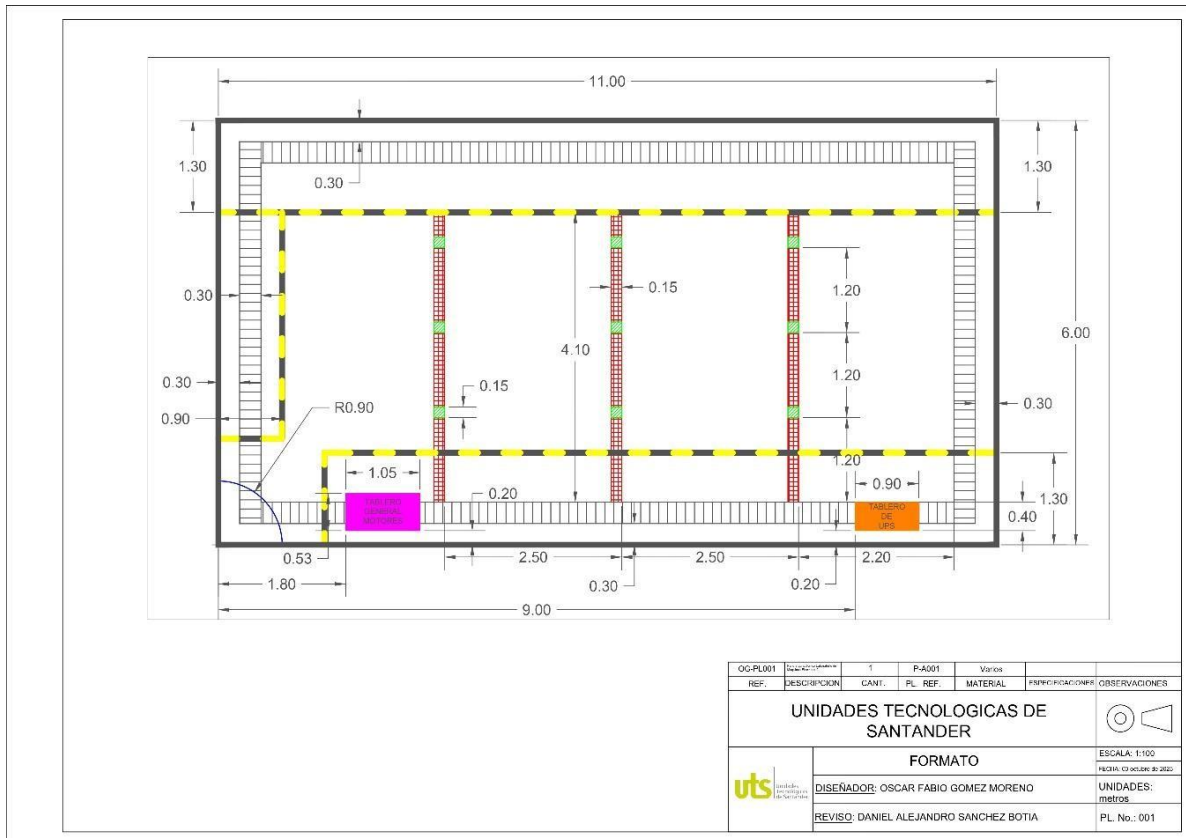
Plano arquitectónico del laboratorio de máquinas eléctricas 2. (Autores, 2025)
